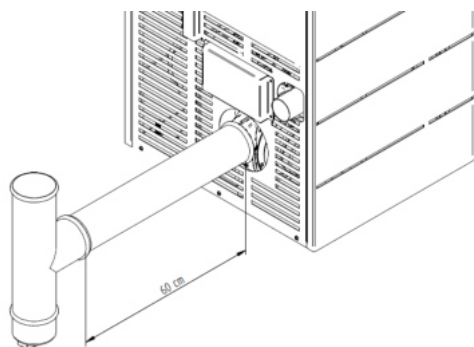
Instalación de una T de inspección a 60 cm del equipo
